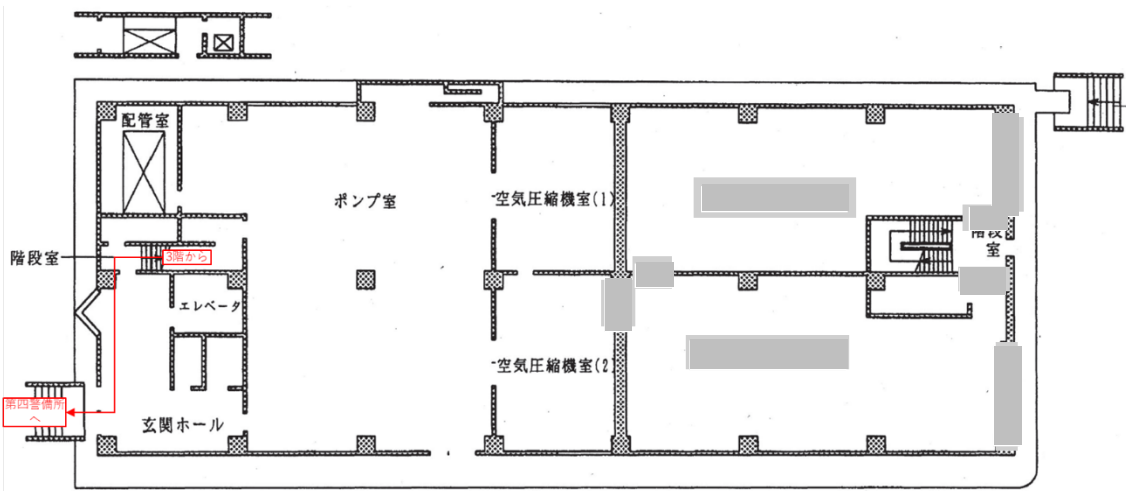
(2) 移動経路 (ユーティリティ施設 地上1F 平面図)
